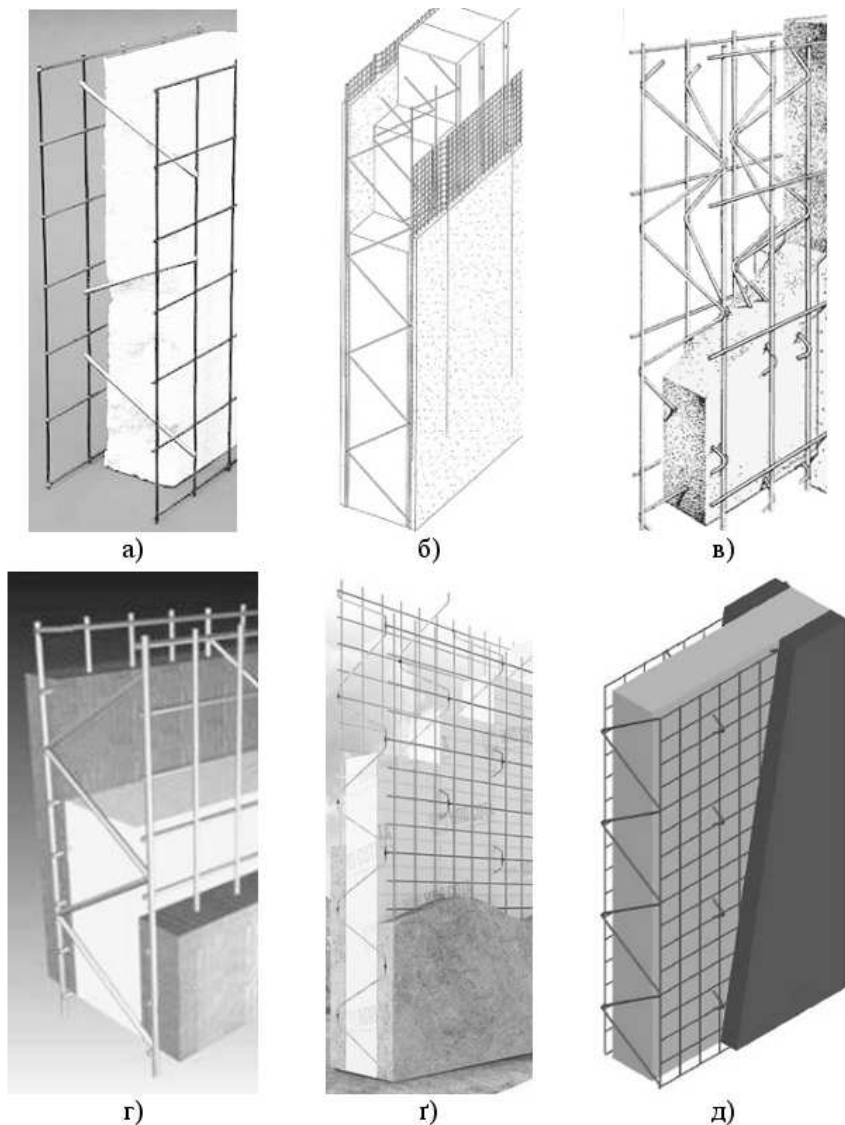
Види поперечного армування тришарових КС з зовнішніми залізобетонними шарами: а) EVG-3D (Insteel Construction Systems Inc.); б) MetrocSCIP; в) Global Panel Solutions, Inc; г) «МДМ-Панель»; ґ) «СОТА»; д) «ТЕКА»
